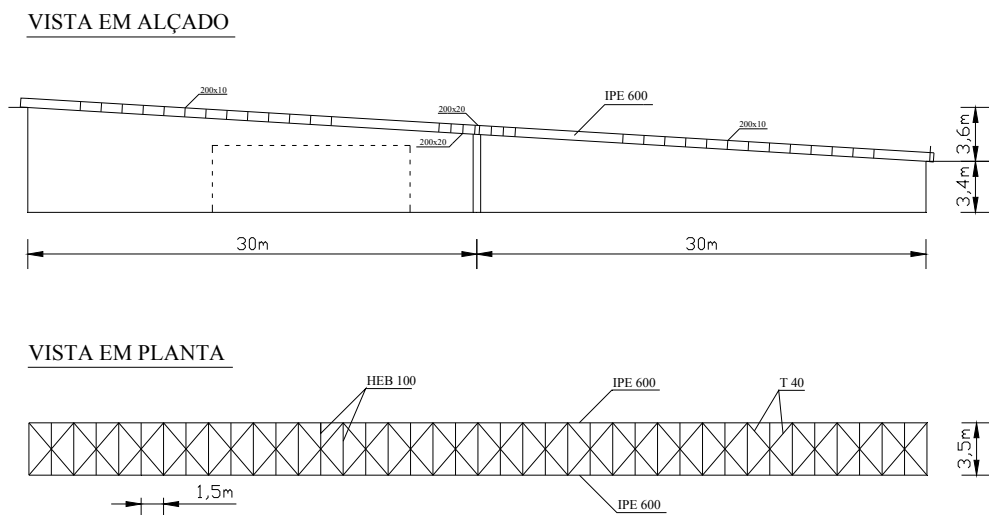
Vistas em Planta e alçado da ponte pedonal.
